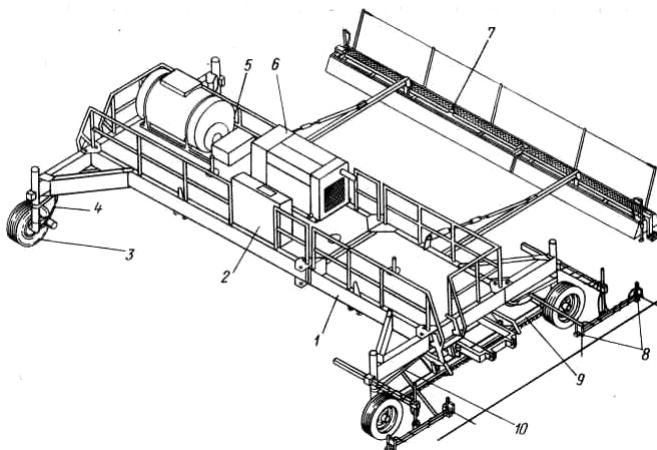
Машина для образования шероховатой поверхности и распределения пленкообразующих жидкостей:
